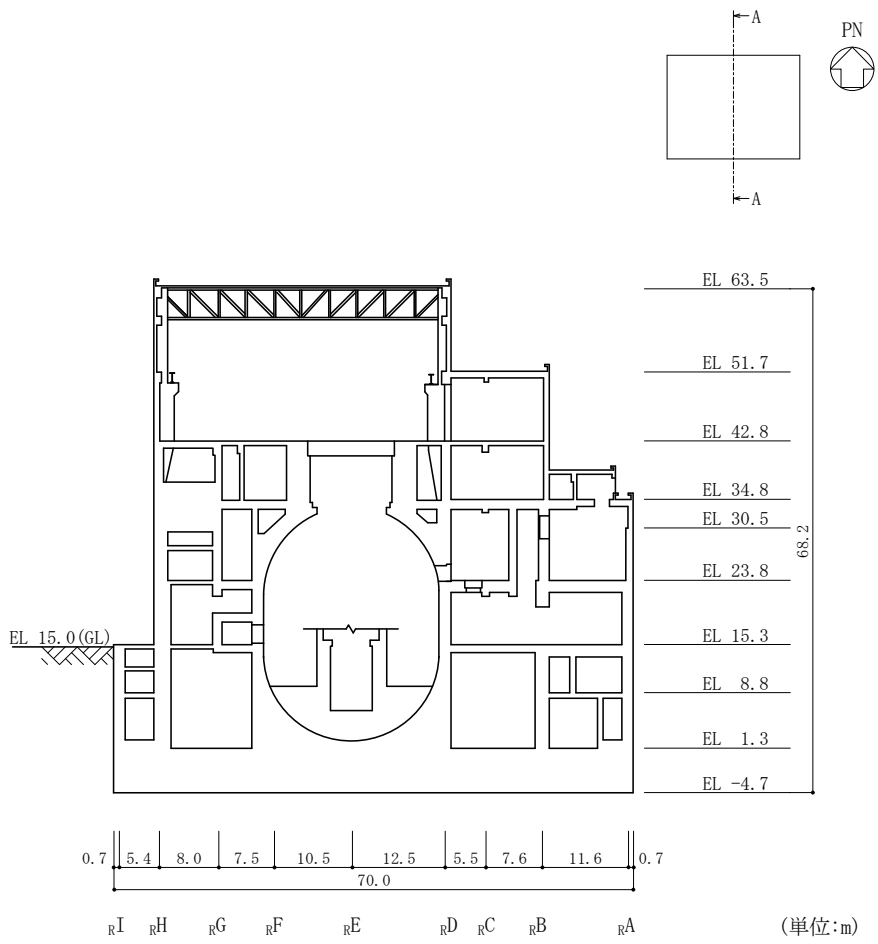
(1) 原子炉建物の概略断面図 (A-A断面, NS方向)
